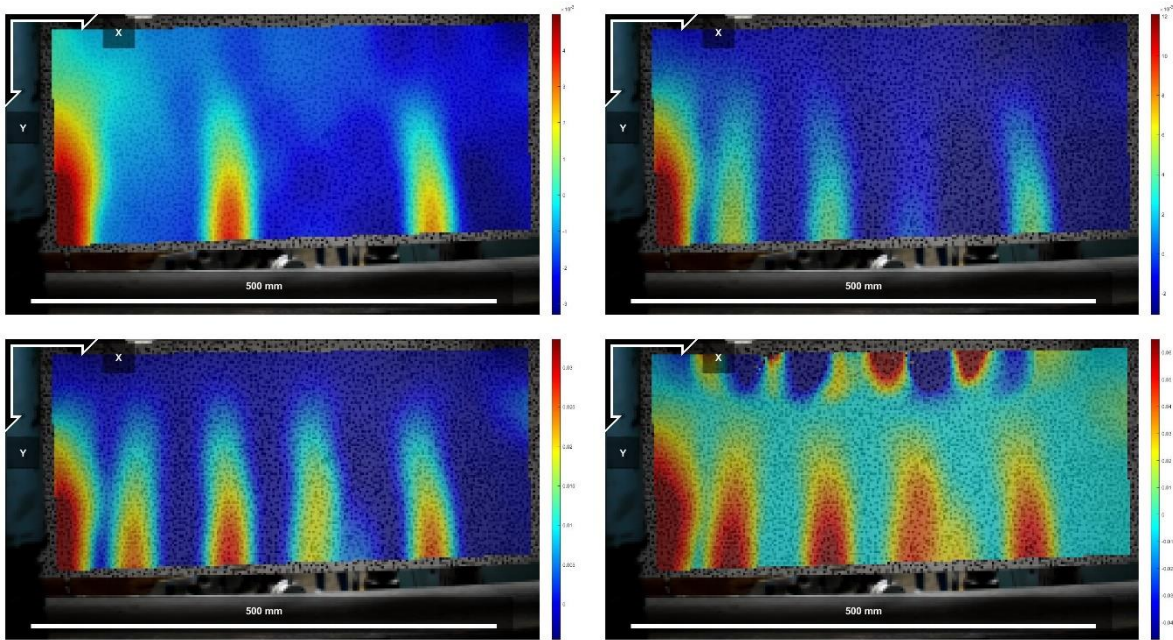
Evolución de los estados de daño en una viga de concreto reforzado sometida a flexión, Green Concrete Beam Competition.
